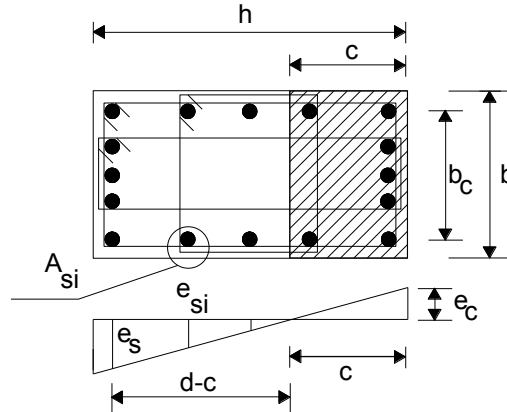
Perfil de deformaciones para una sección rectangular de concreto reforzado
